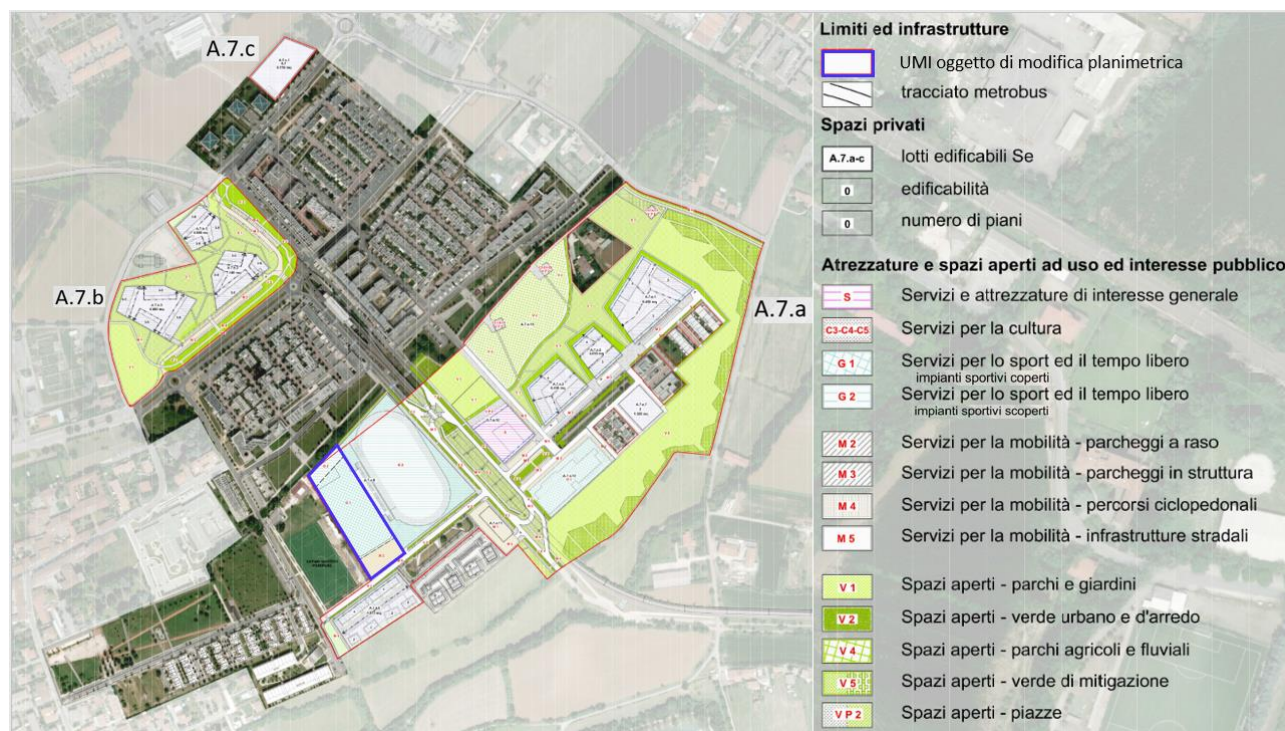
Modifica planivolumetrica dell'UMI A.7.a.9
